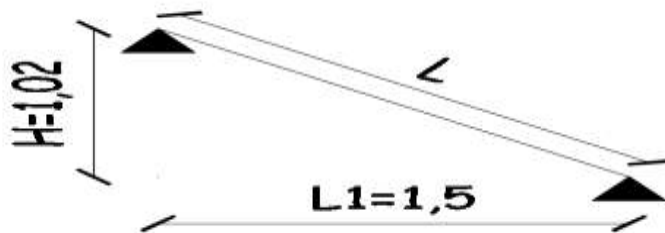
Schéma du 1^{er} type d'escalier.
